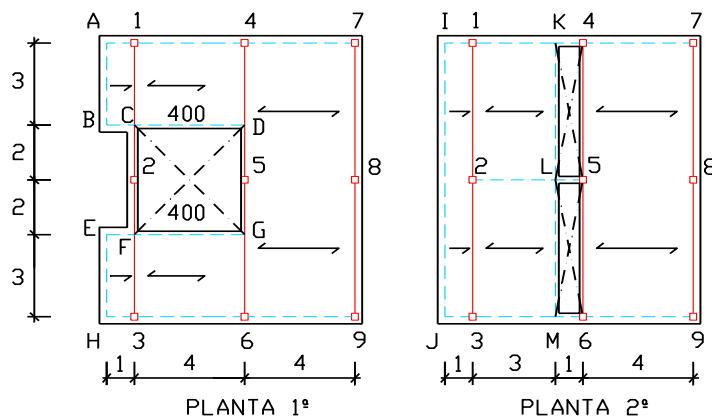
Esquema estructural de plantas ejecutadas con forjado unidireccional.
